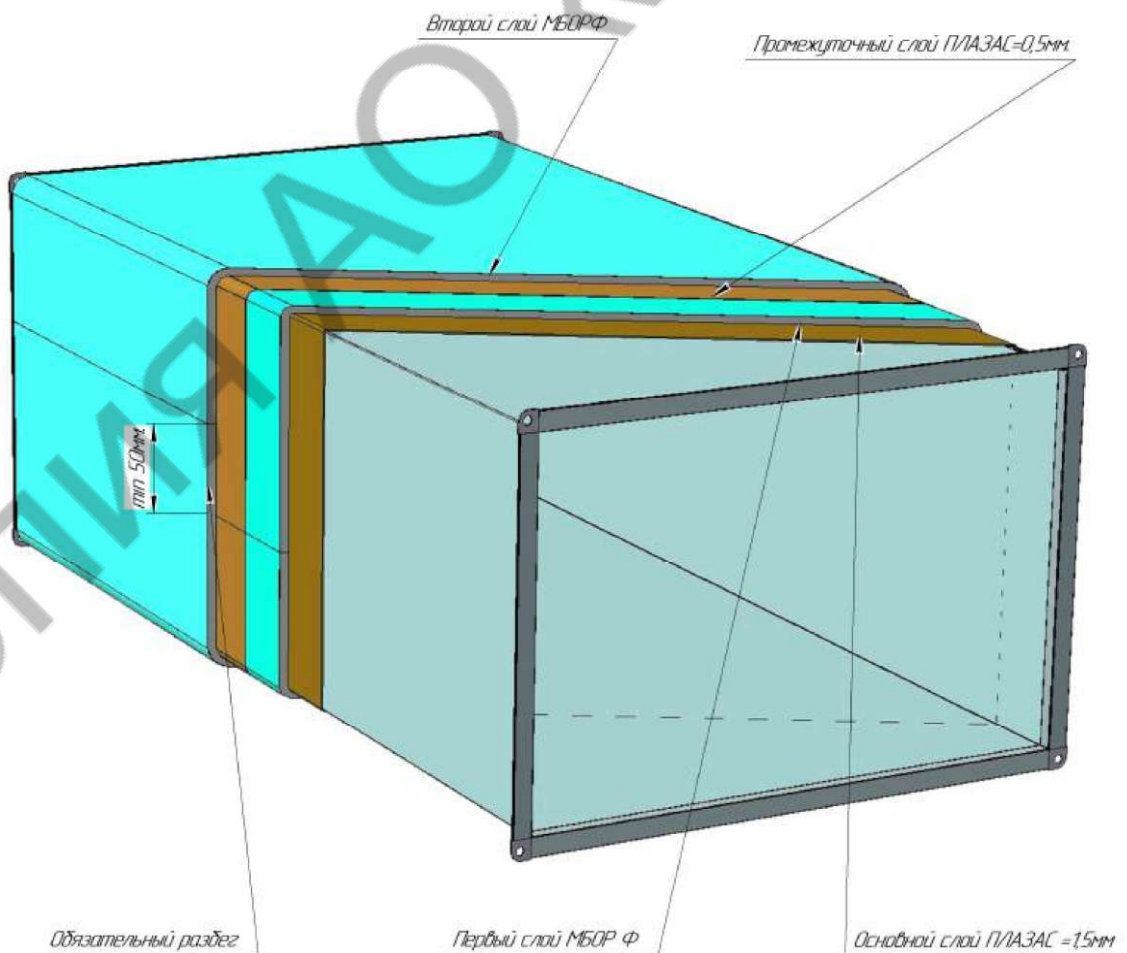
Монтаж системы «ЕТ ВЕНТ» на собранные воздуховоды
